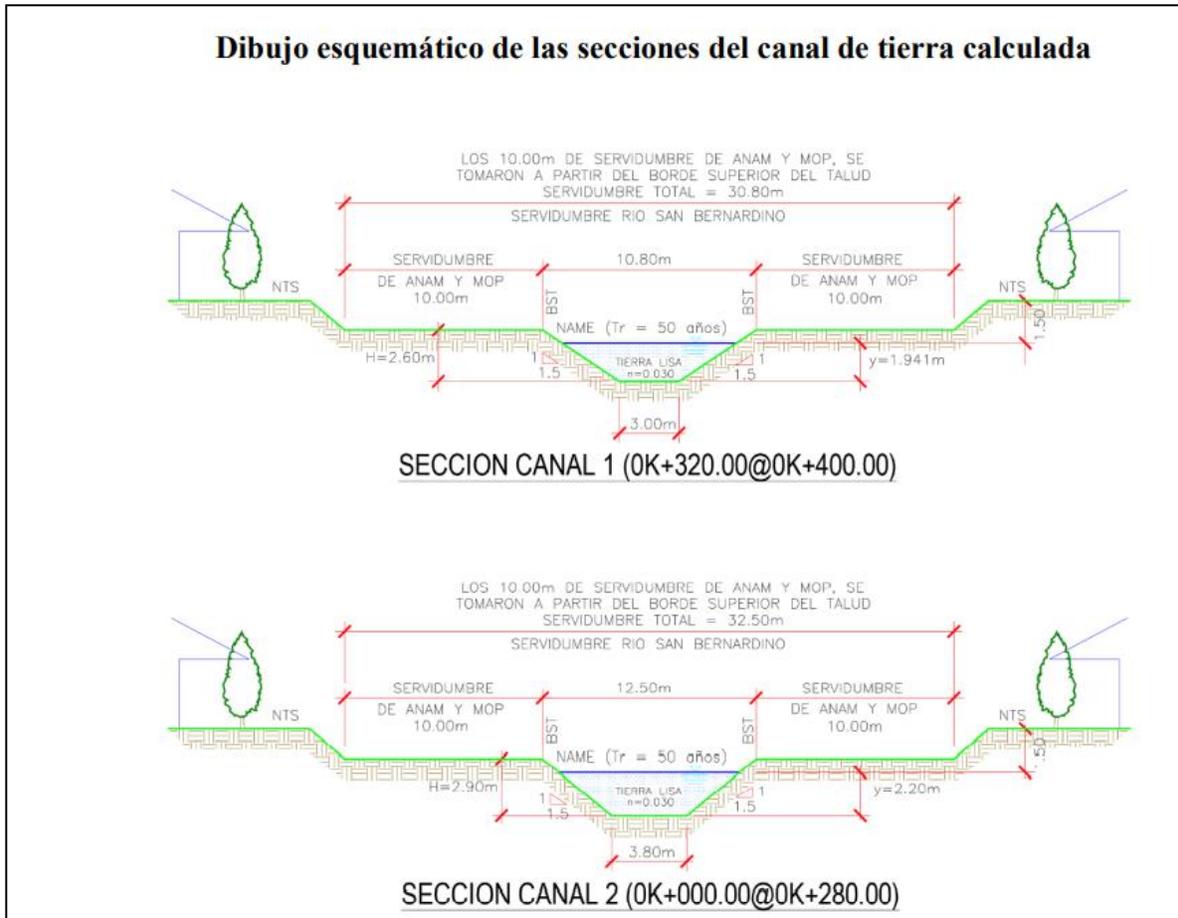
Vista de la geometría de las obras civiles previstas para el río San Bernardino, fuente Promotor.
